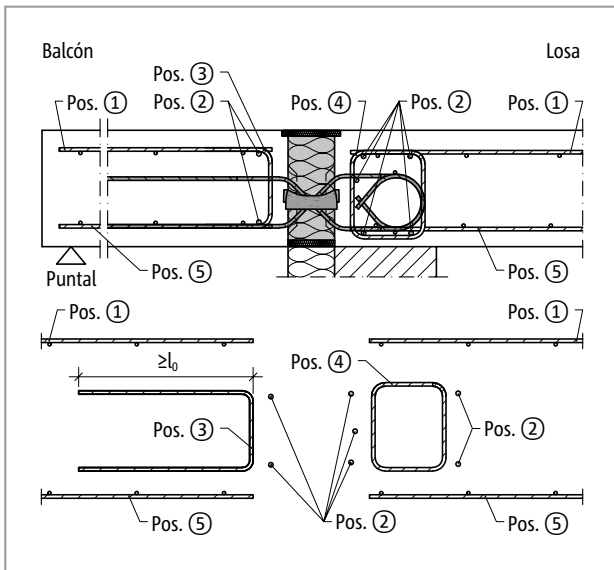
Schöck Isokorb® T tipo Q-VV1 hasta Q-VV5: Armadura in situ
